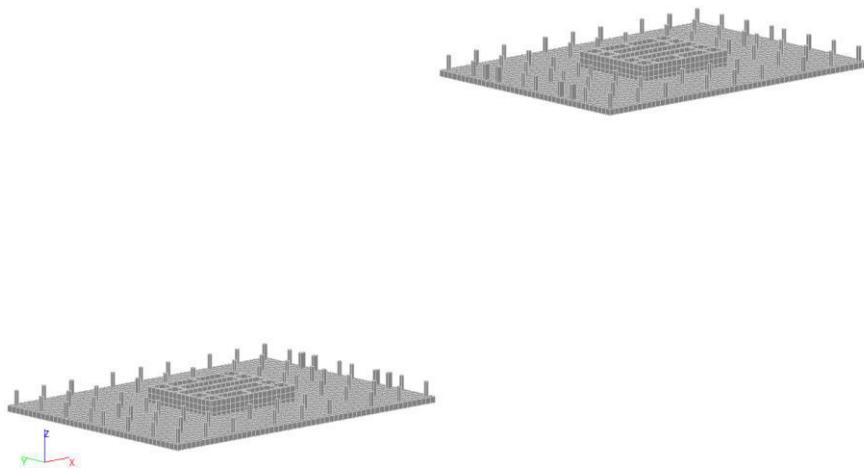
Конечно элементная схема фундаментной плиты
